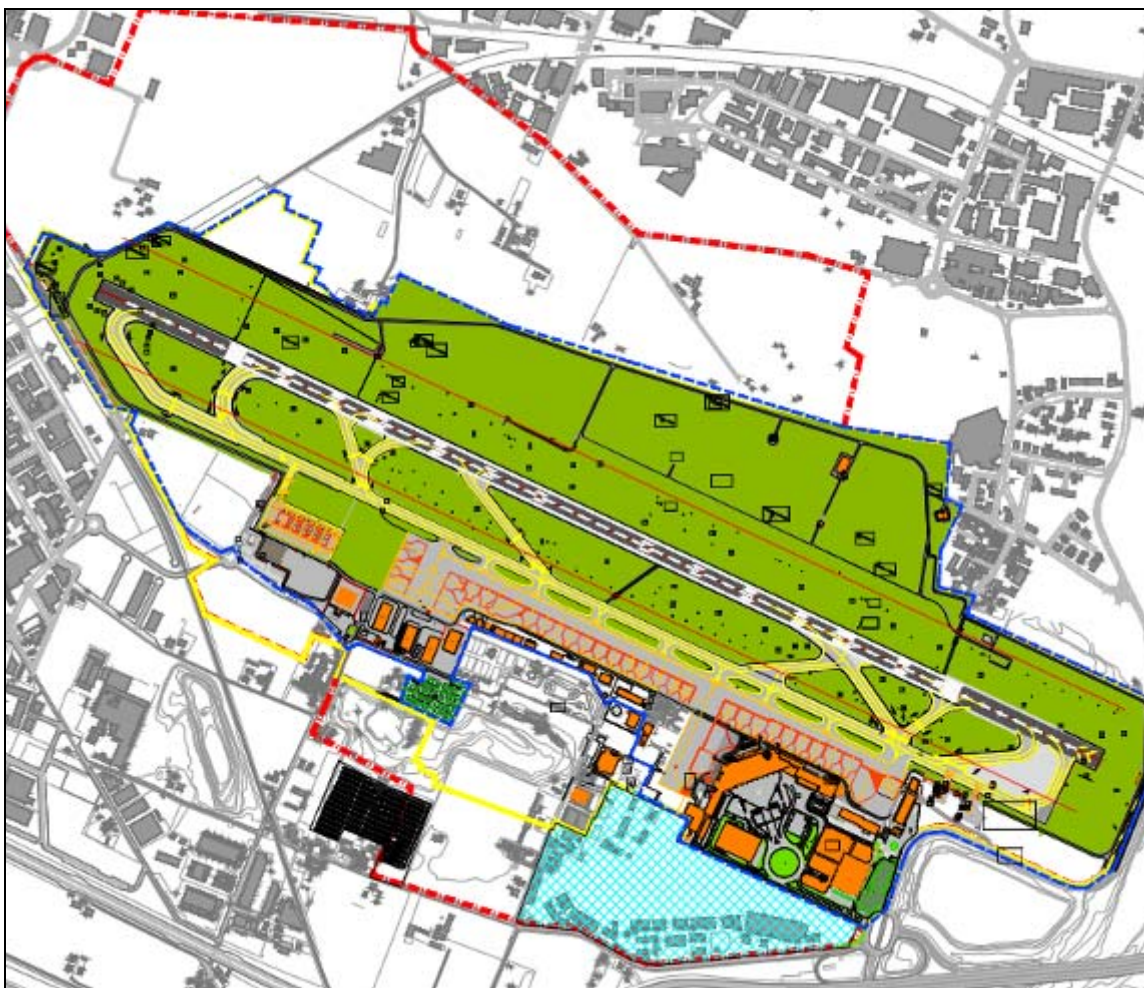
Planimetria con rappresentazione dello Stato di Fatto
